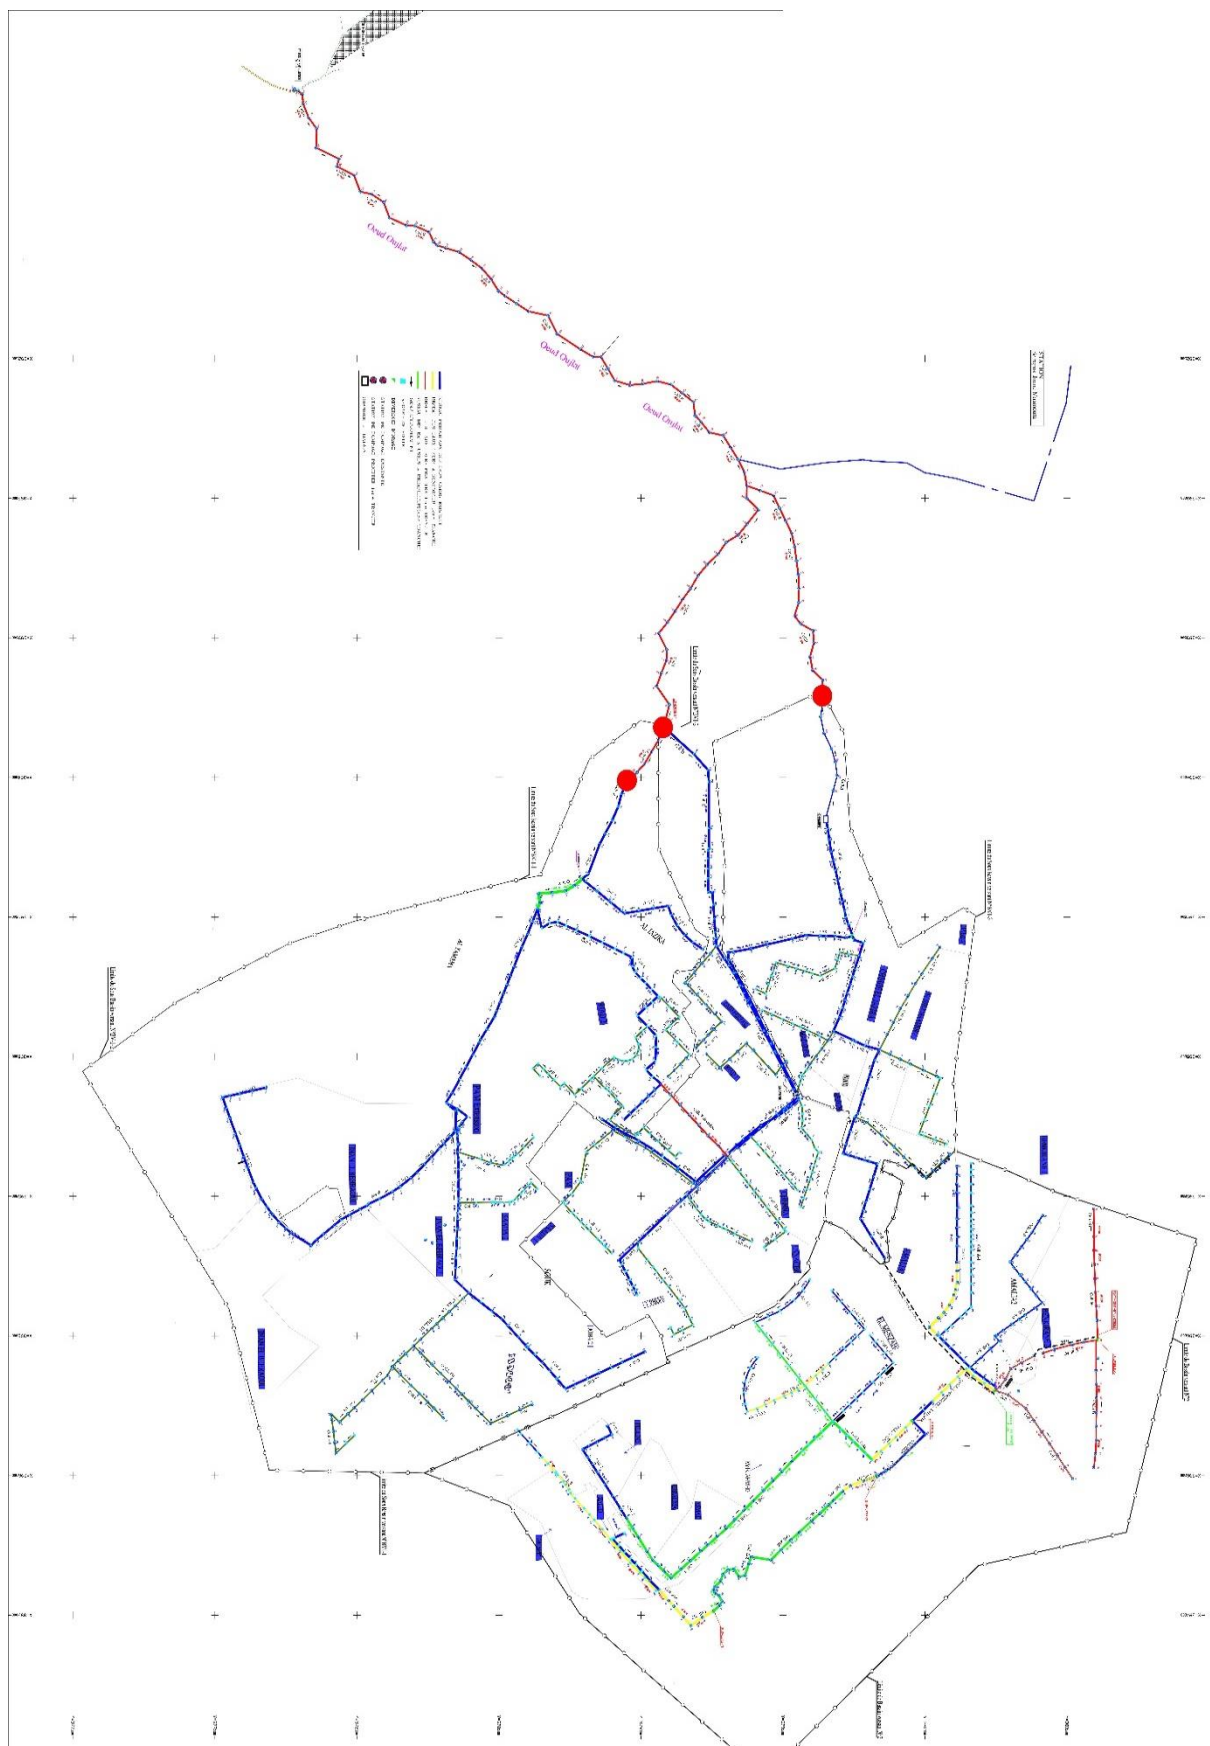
Plan du réseau de eaux usées de la ville de S.A.B
